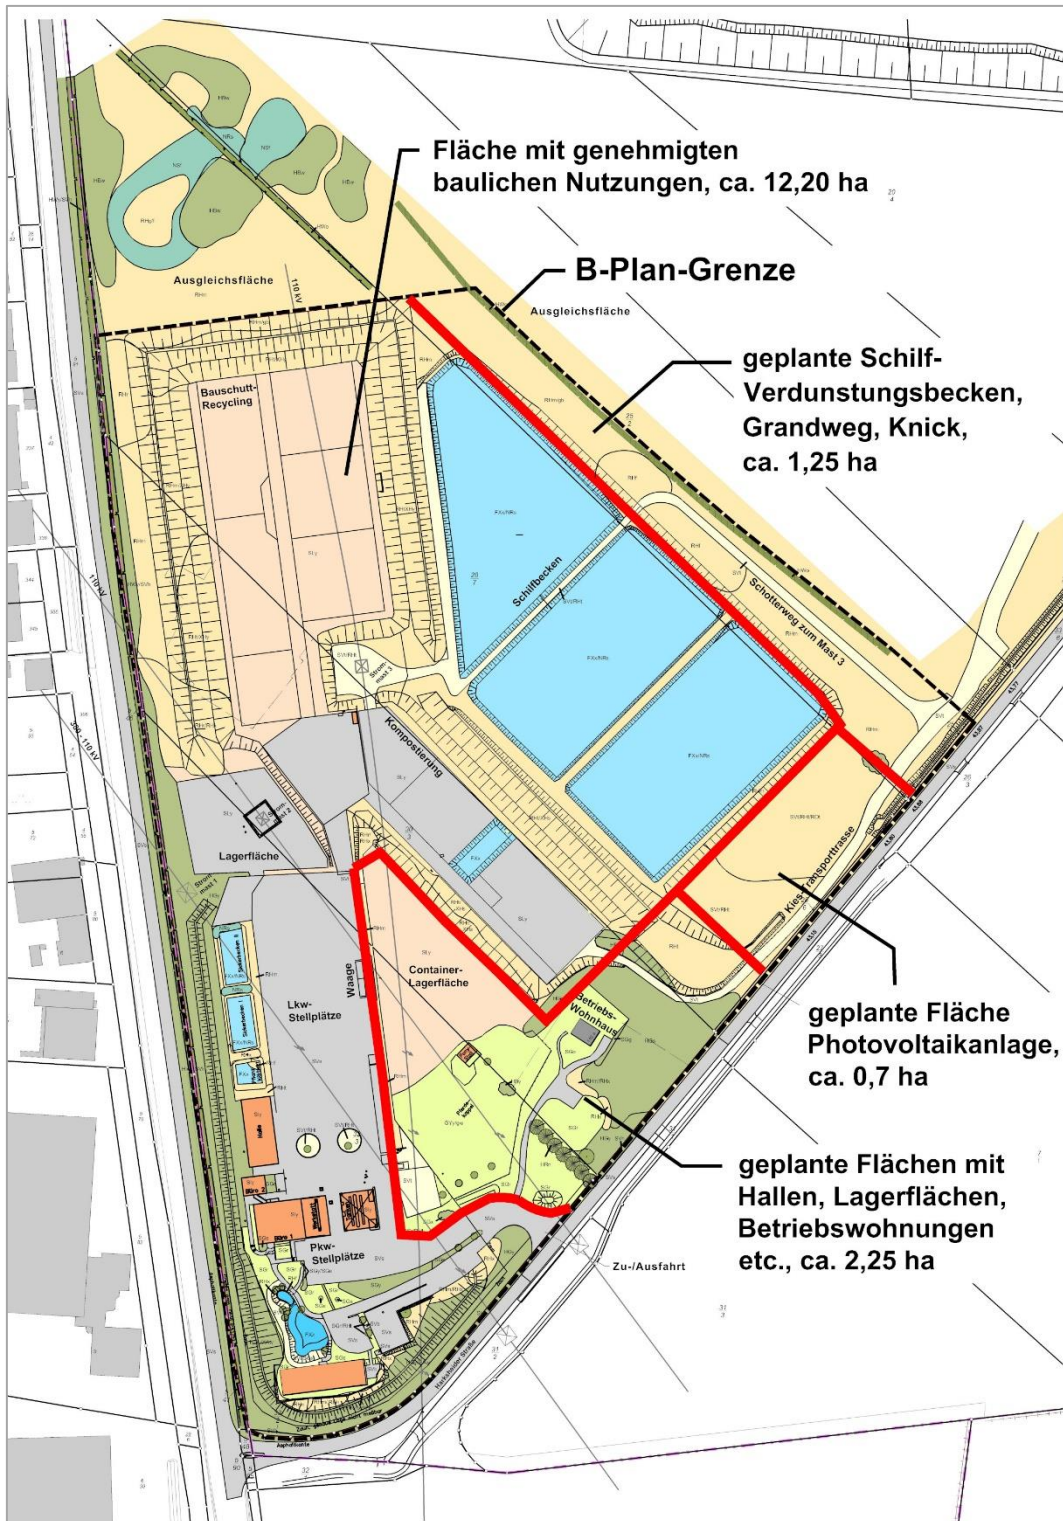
Plangeltungsbereich mit Darstellung Bestand und Planung
